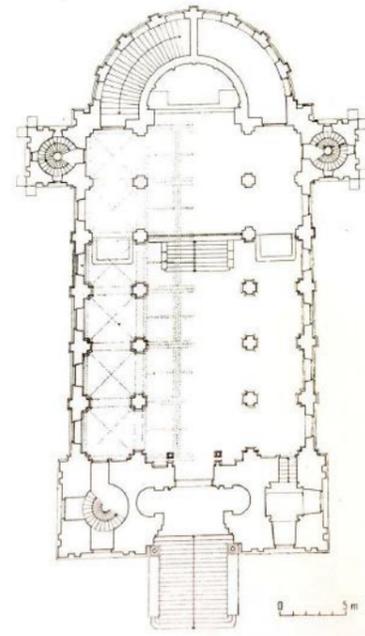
Grundriss der Pfarrkirche von Fót
